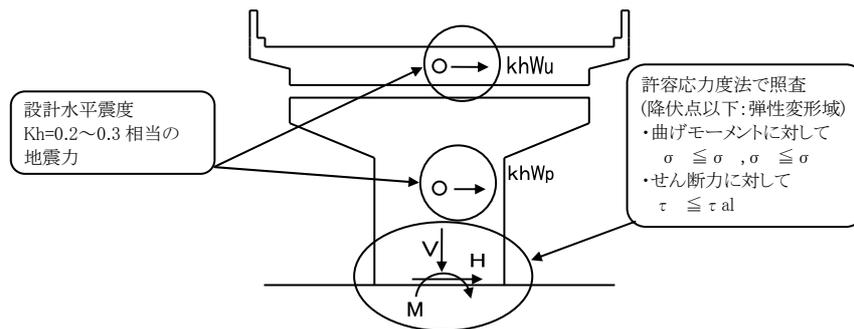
レベル 1 地震動による耐震性能 1 照査の概念
